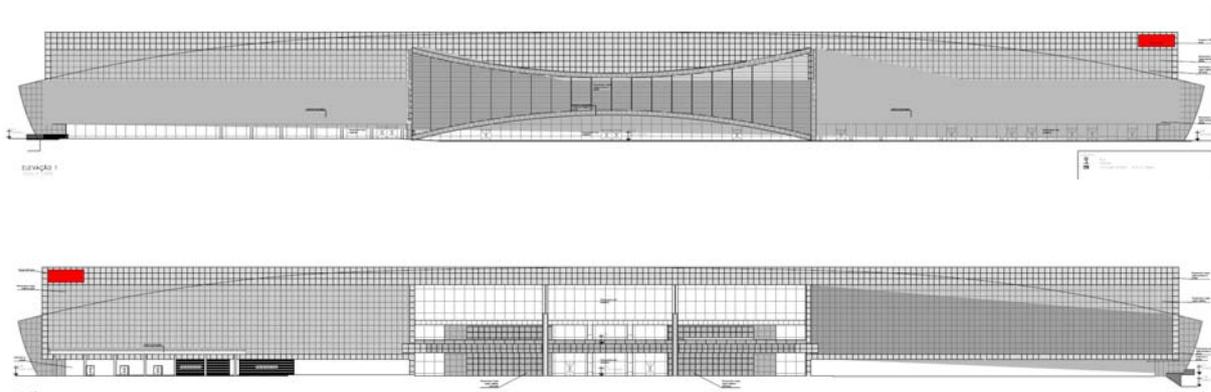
Proposta original de alteração das fachadas do CCUG.
